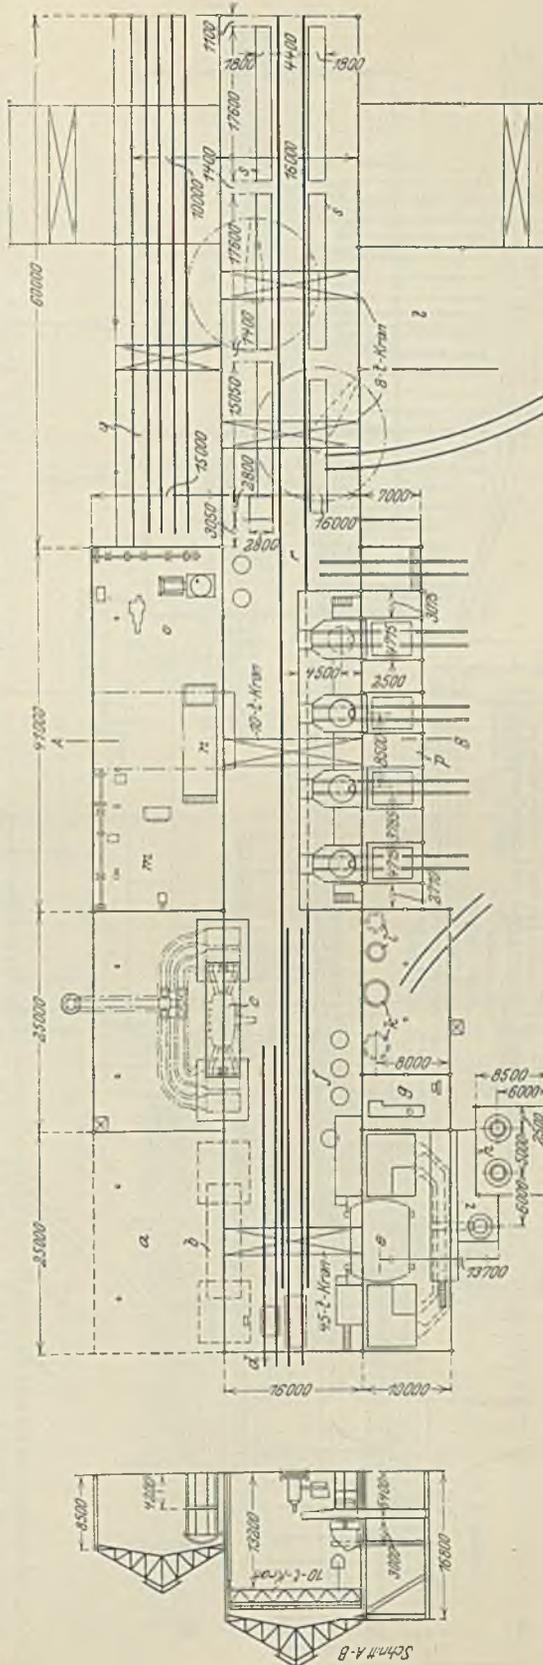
Grundriß des Stahlwerks in Clabecq.
